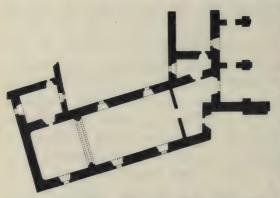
Balladolid. Erste Kollegskirche. Grundriß.
